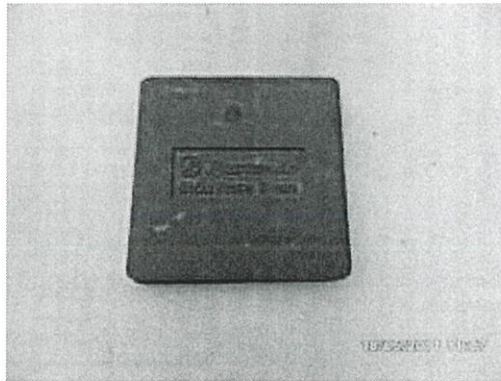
แสดง Joint Detail JW1 ที่ใช้ Plate ขนาด 75x74x5 mm.
